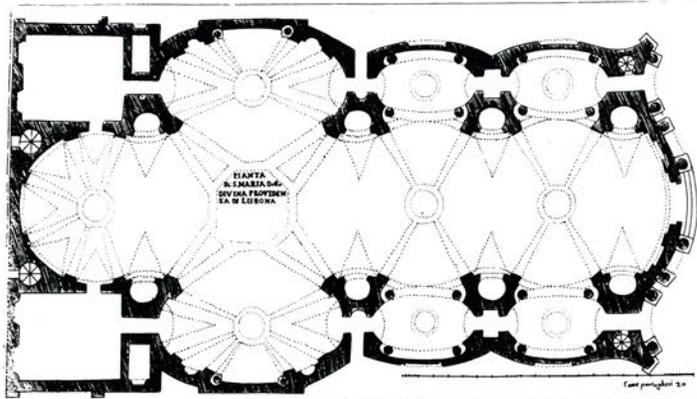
Planta de Sta. María de la Divina Providencia (Guarini).
